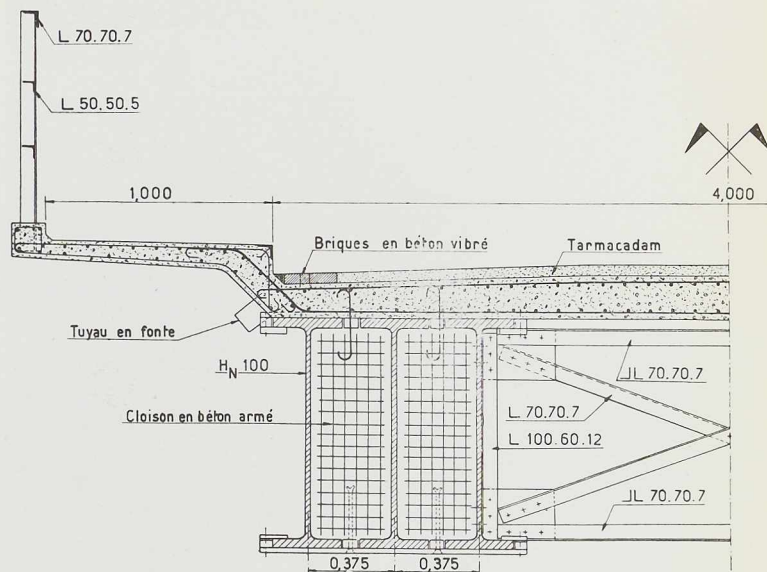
Demi-coupe du tablier montrant notamment les brides et les diaphragmes en béton reliant les poutrelles H.
